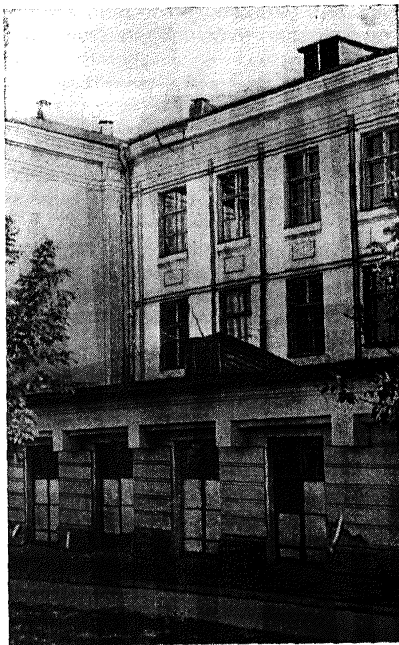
Деформация здания, построенного на просадочных грунтах.
